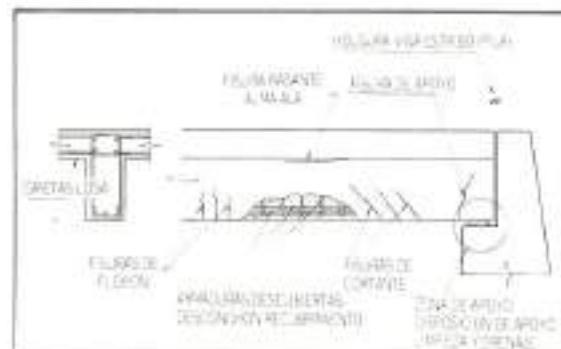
Zonas de inspección superestructura hormigón. Defectos más frecuentes.
